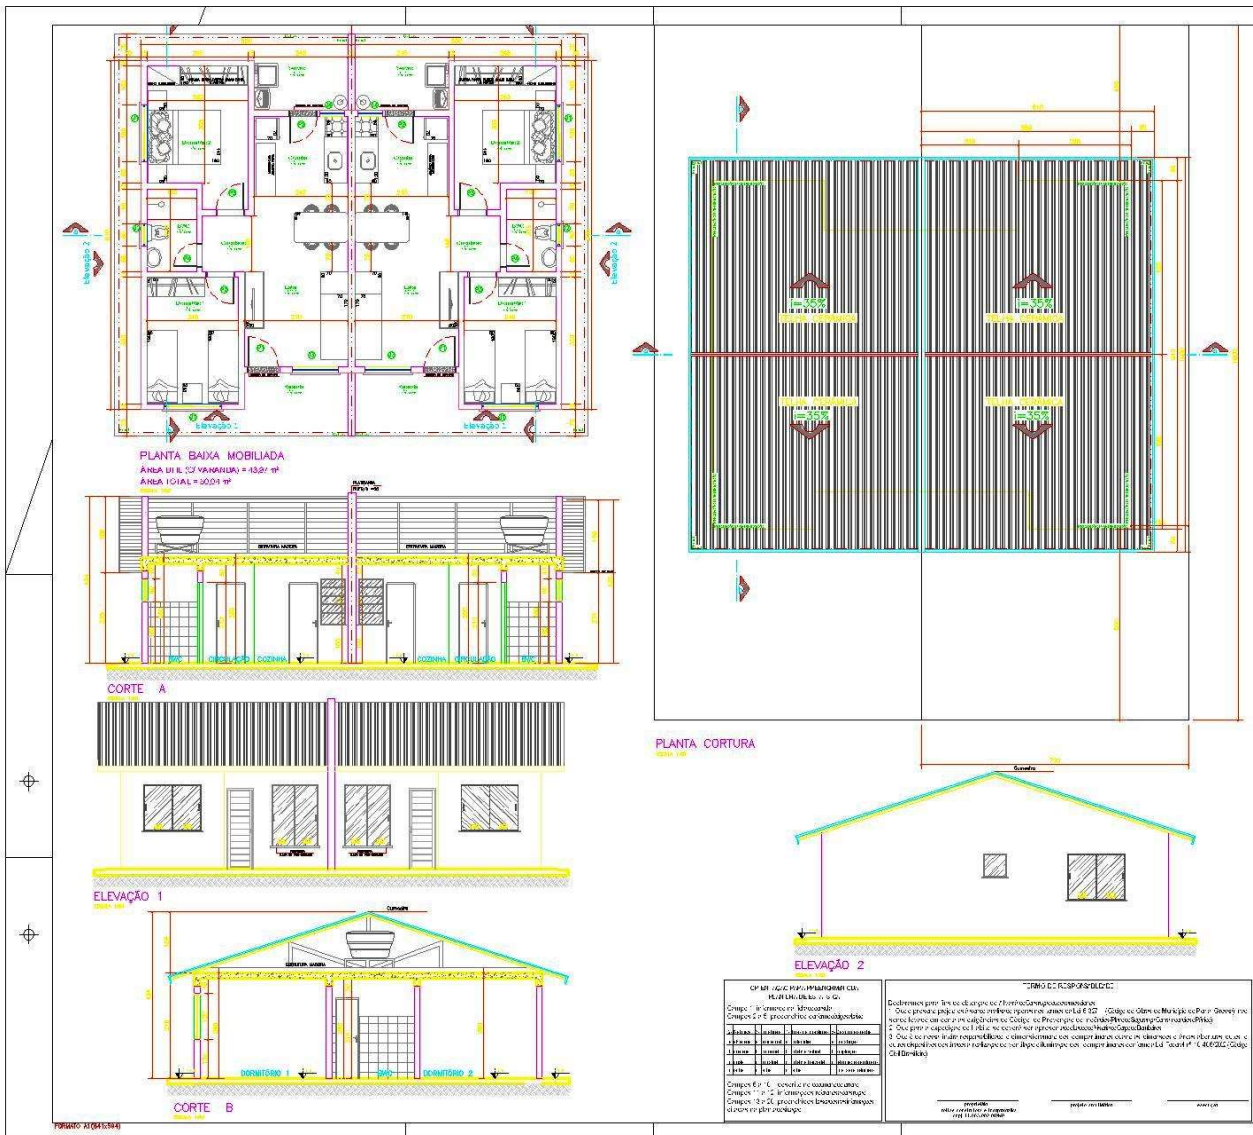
Planta baixa, cortes e vistas - modelo 2 quartos.
